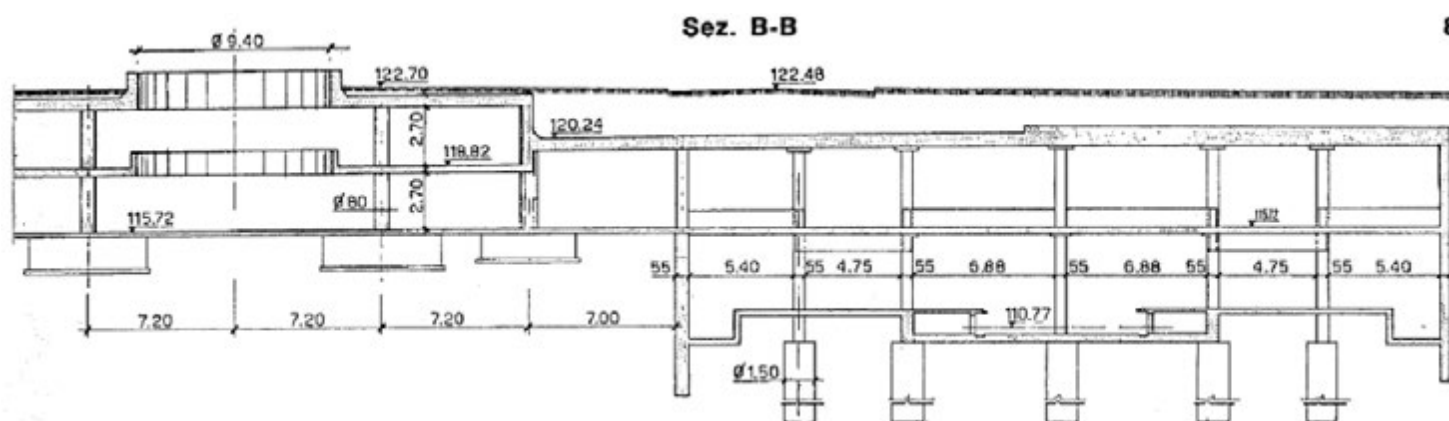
| Sezione del manufatto della Stazione Fs Centrale della MM in Milano
